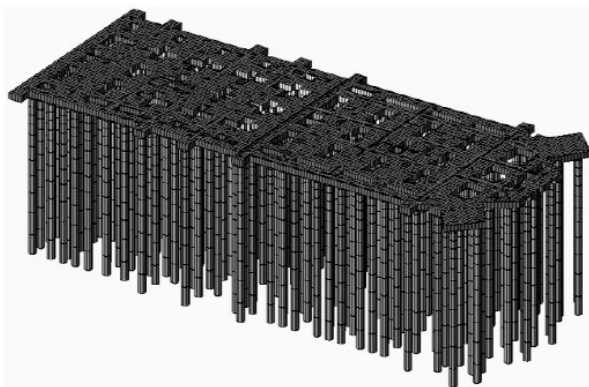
3-Д вигляд фундаментного ростверку будівлі
